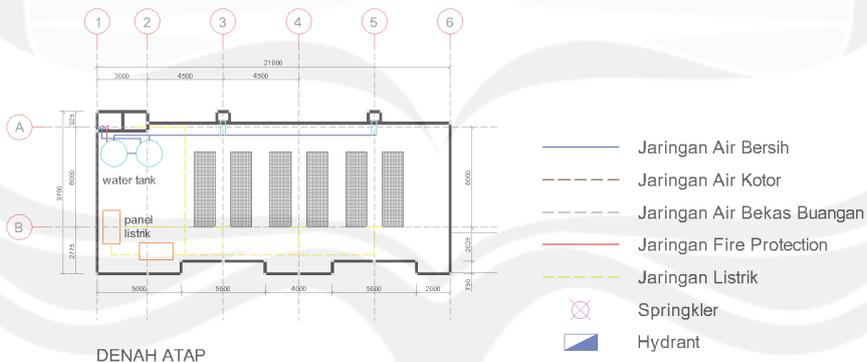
Utilitas Blok 2 Lantai 2
